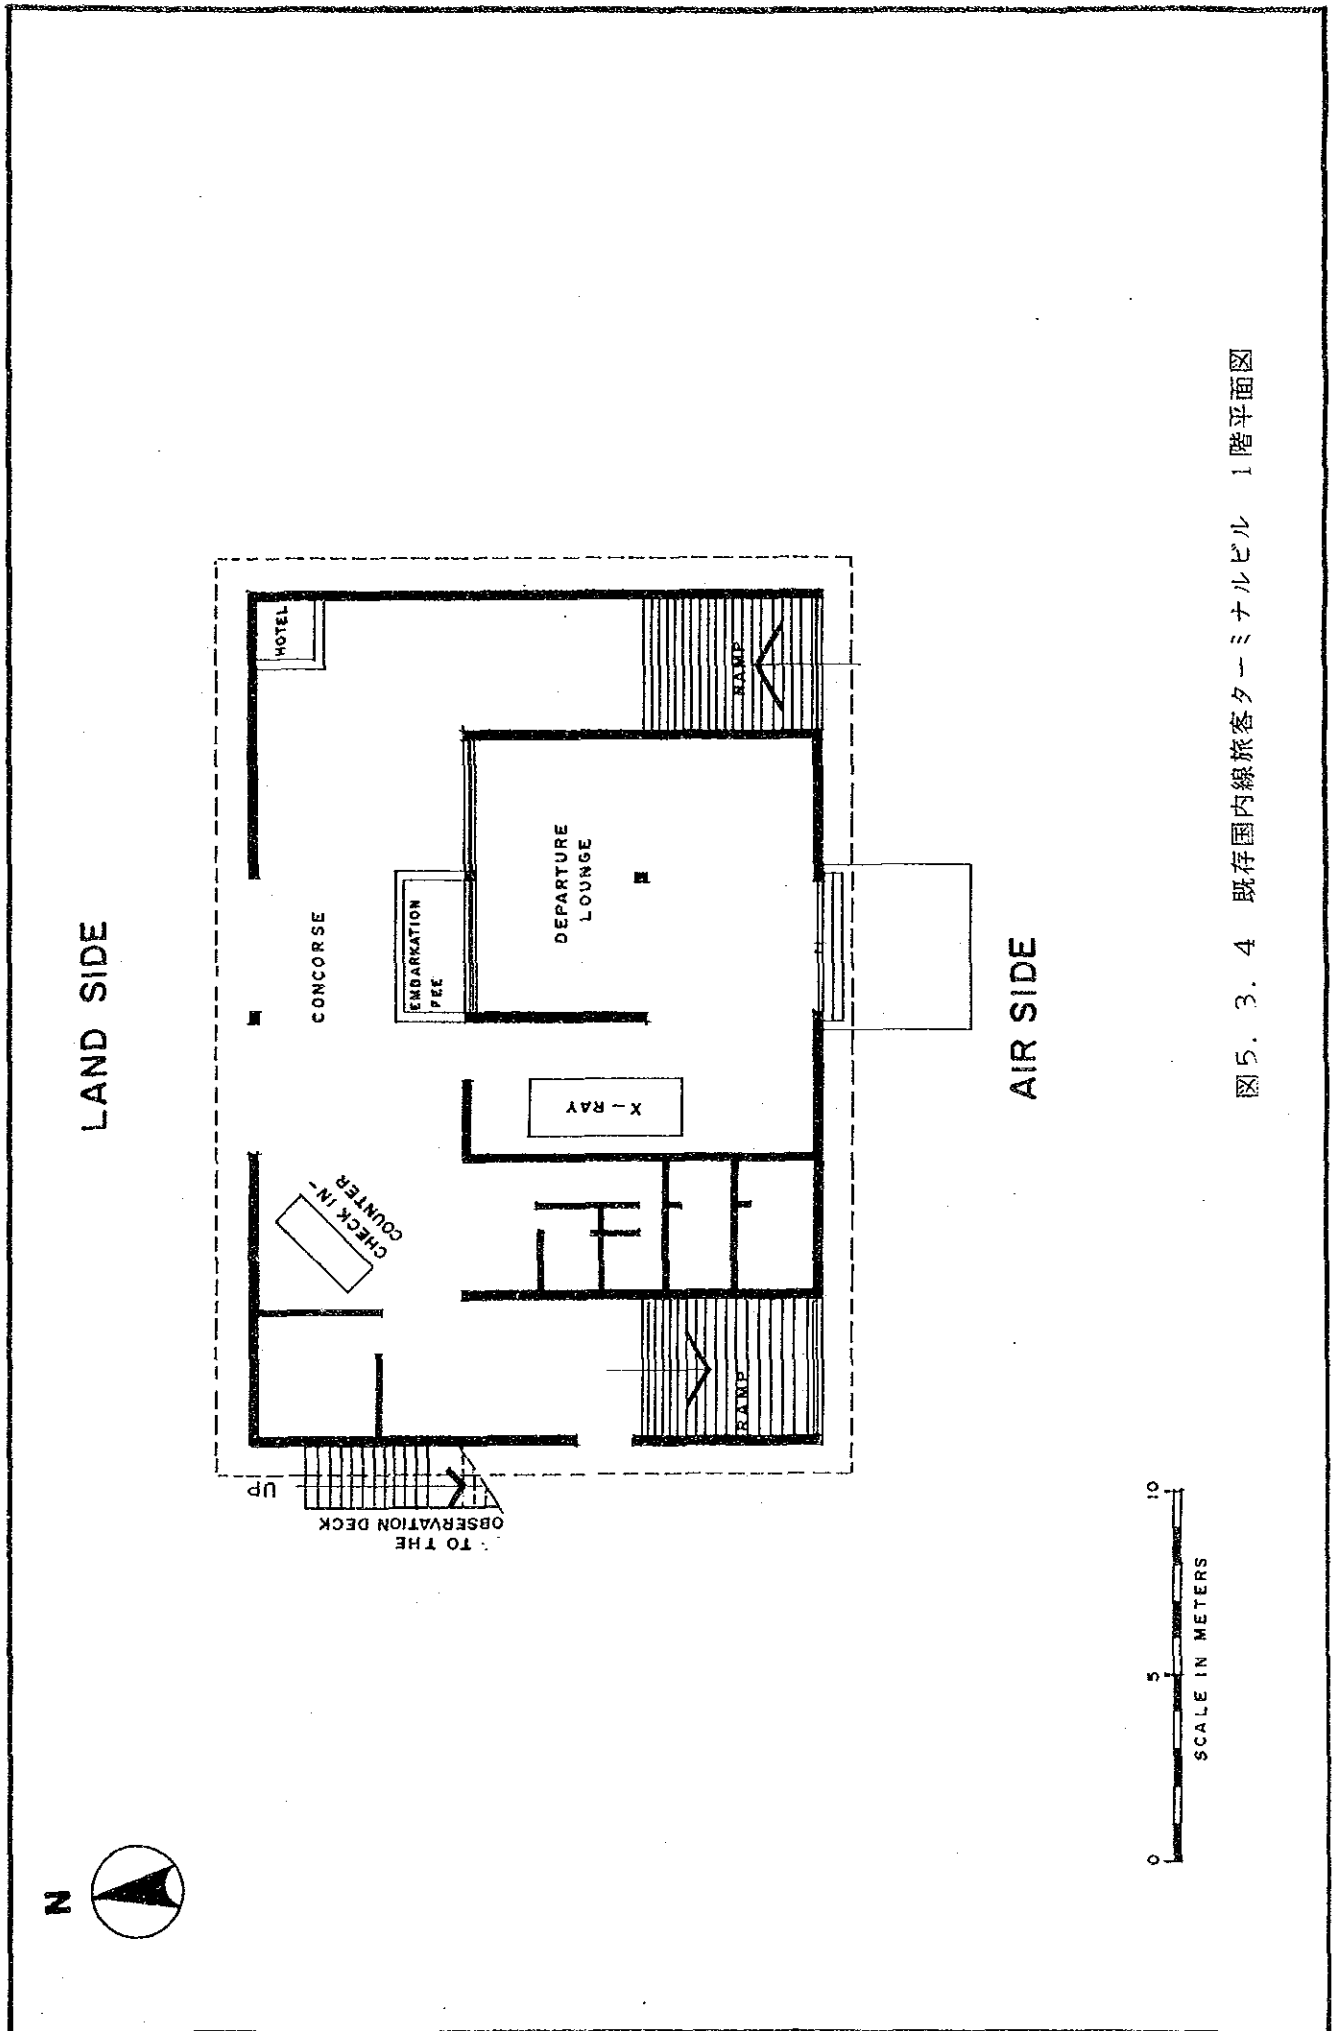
3. 4 既存国内線旅客ターミナルビル 1階平面図
